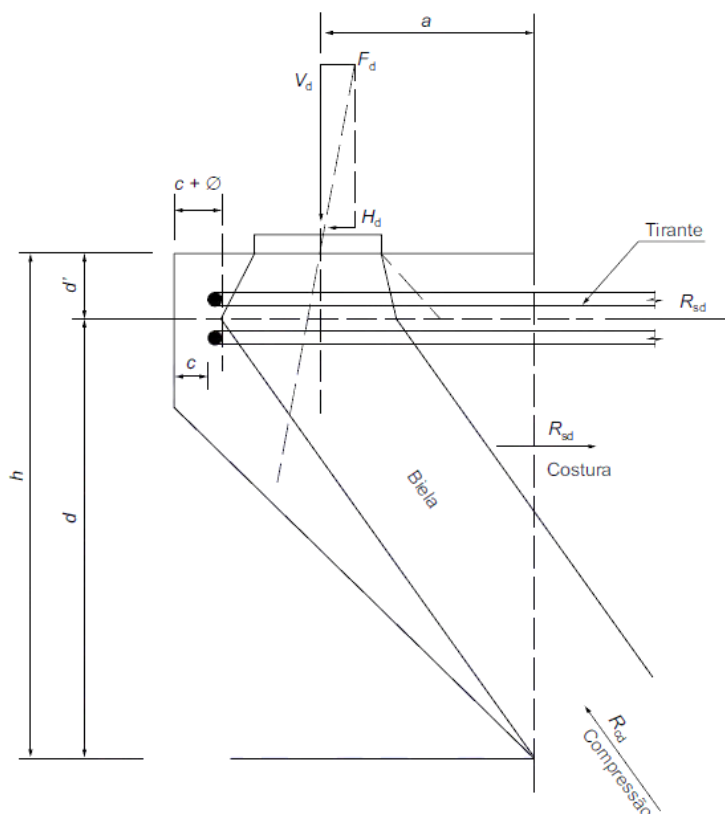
Parâmetros de Cálculo do Consolo Curto.
